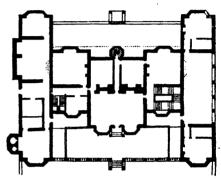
, Grundriß des Holland houfe in Renfington. Rach R. Blomfield, "A history of Renaissance Architecture in England". London 1897.
